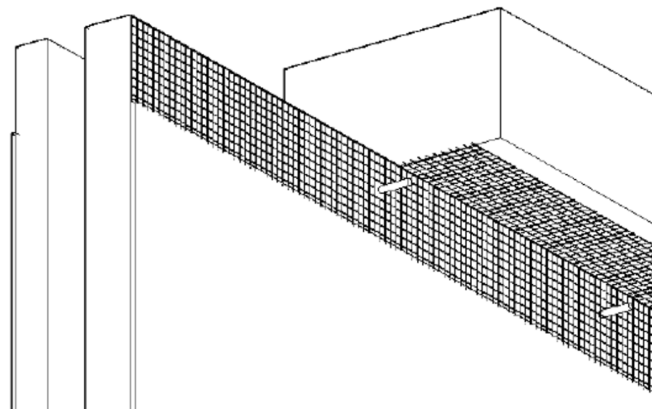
Conexión perimetral a placas y columnas (vista tridimensional): Paso 3.
